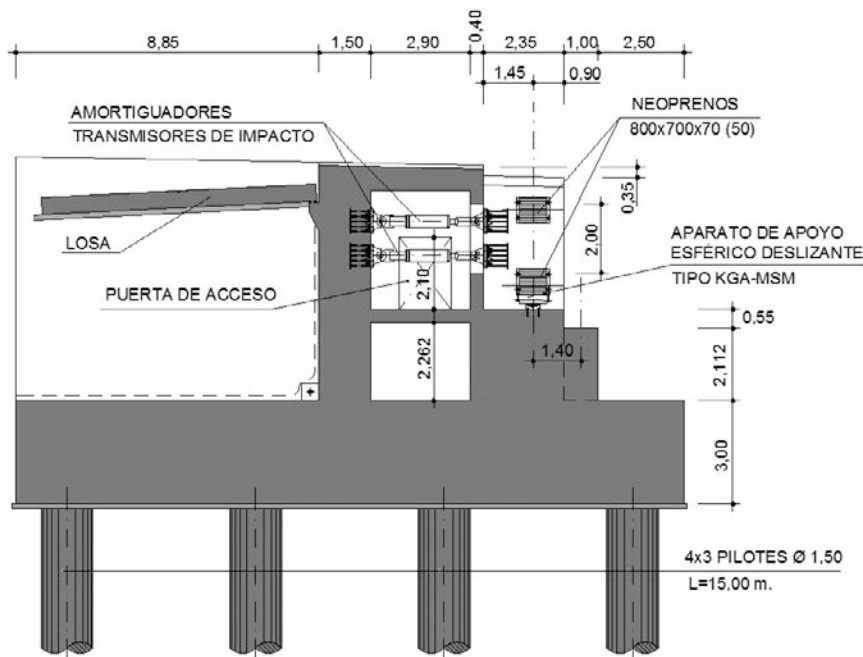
Estribo A2 de la estructura SG28 (segunda fase), con cámara accesible para amortiguadores longitudinales
